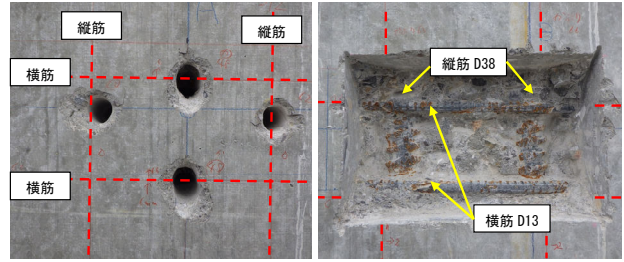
ドリル削孔状況 写真-2 はつり出し状況
